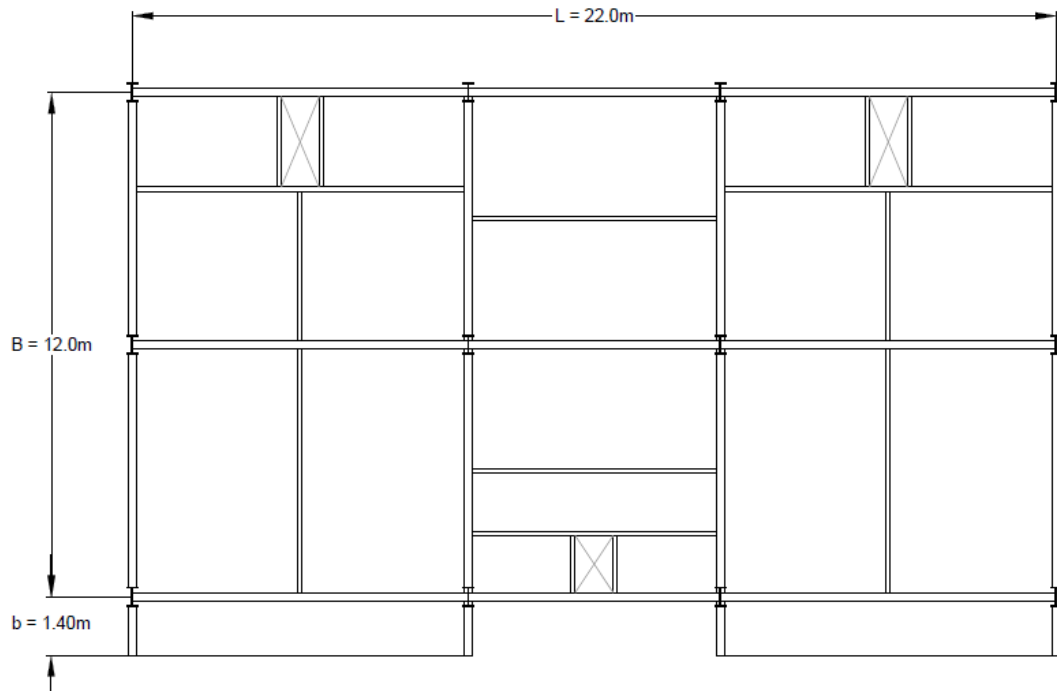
Configuración geométrica en planta del edificio de baja altura.
